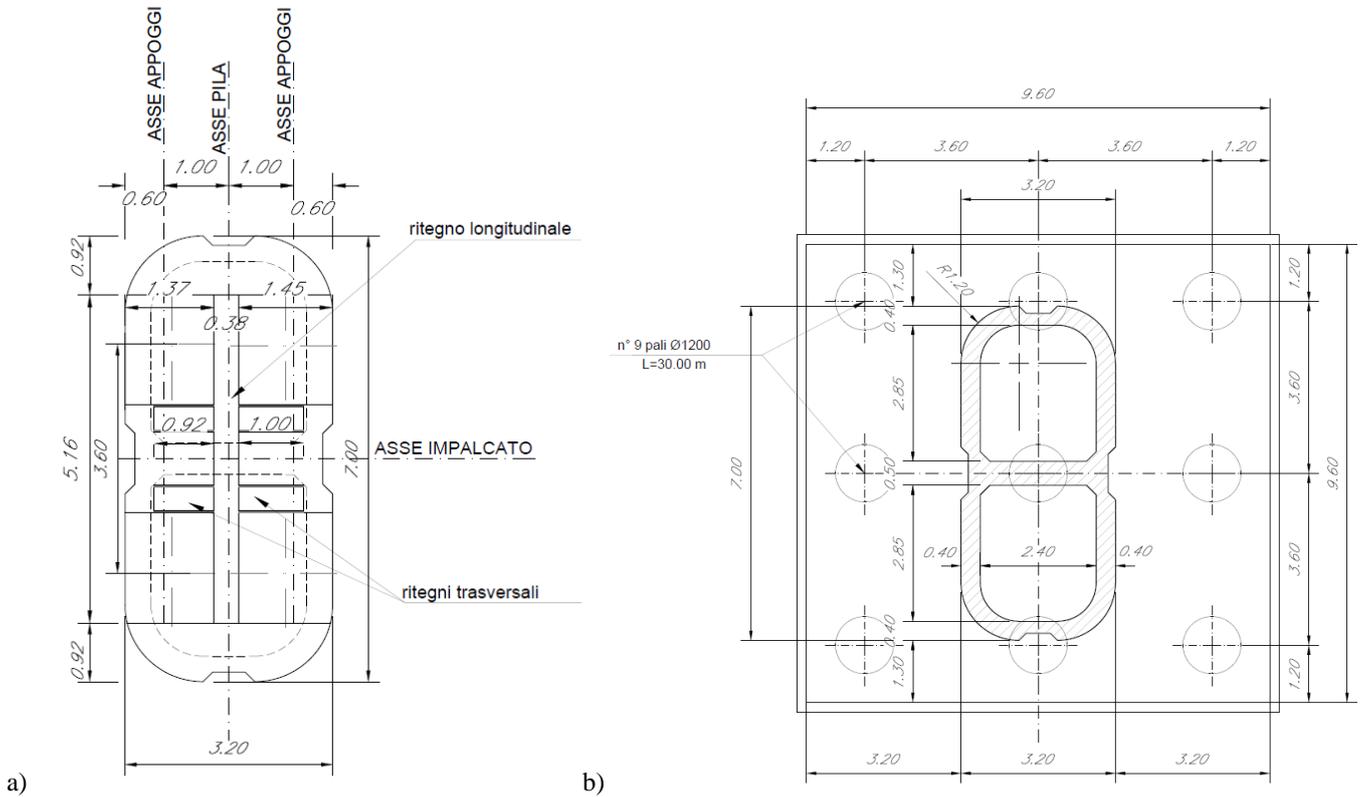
Vista in pianta pila- a) ; sezione di dettaglio fusto pila b) sezione di spiccato
